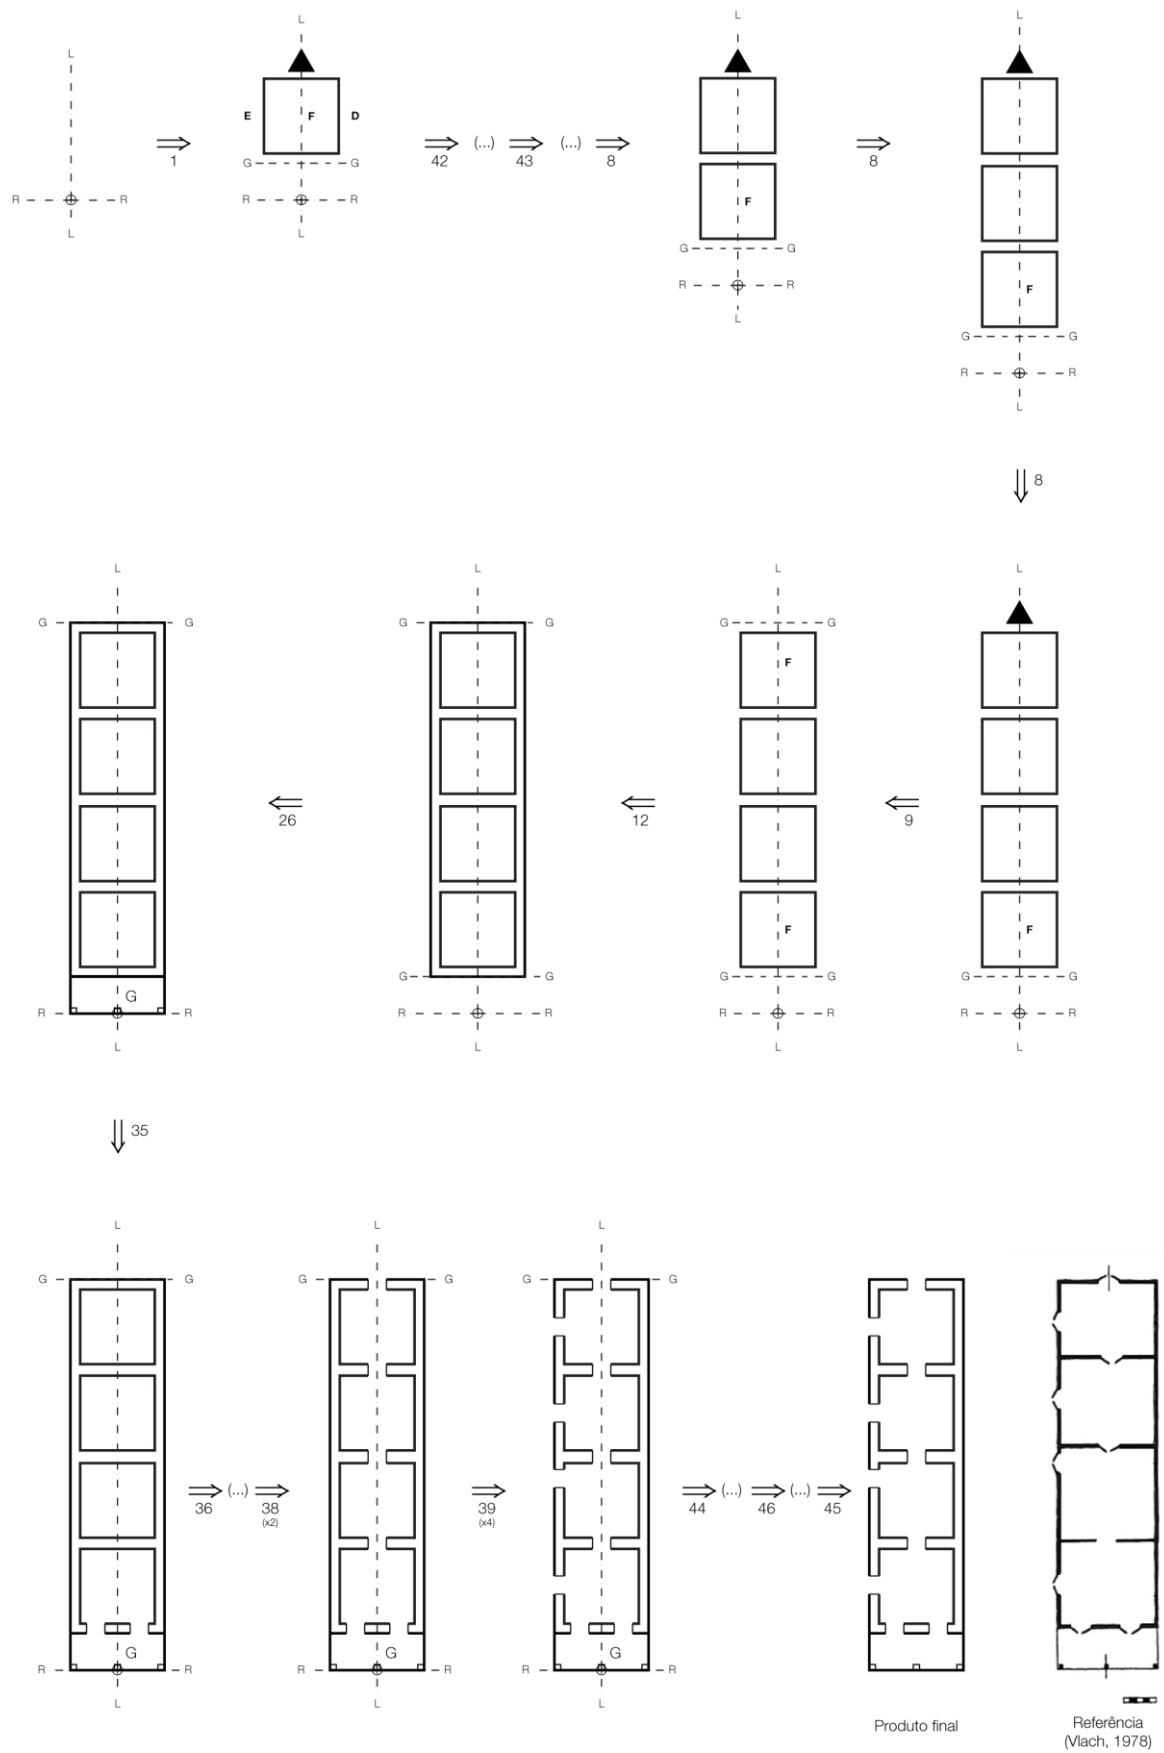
Demonstração da gramática de forma para uma planta do tipo Shotgun.
